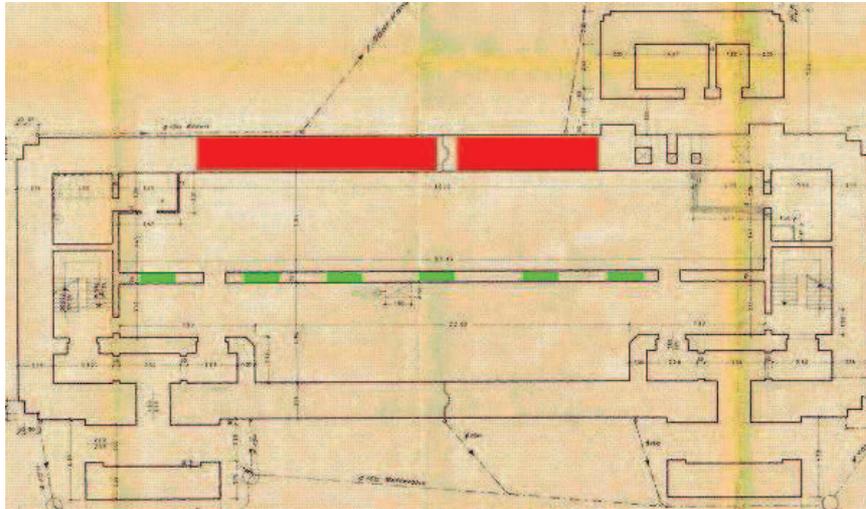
, Grundriss EG und 1.OG
